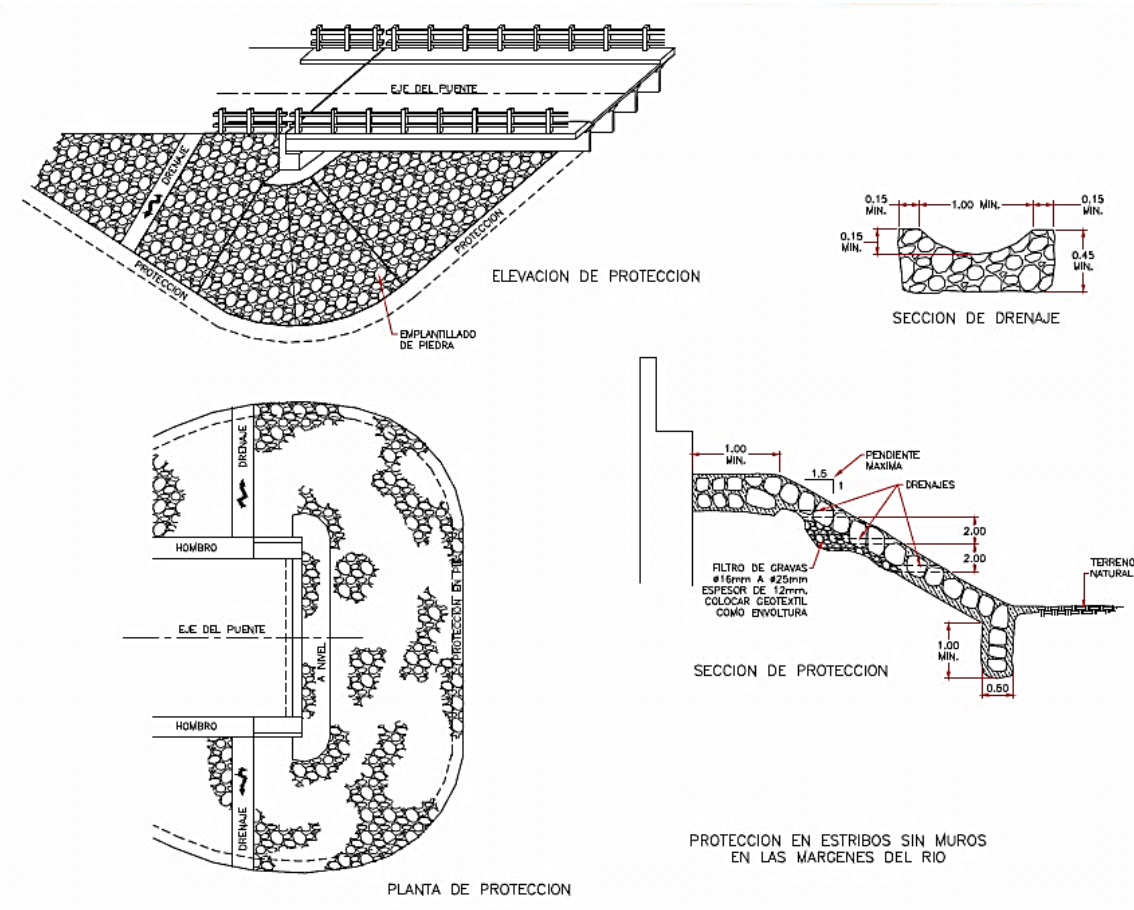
Protección para estribos sin muros en las márgenes del río, con emplantillado de piedra.
